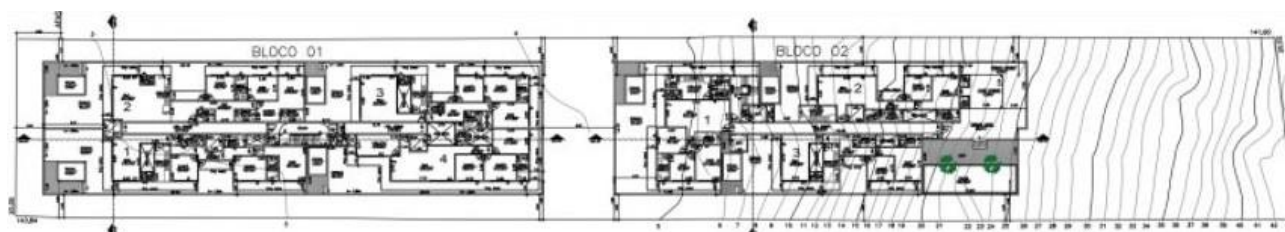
Pavimento Cobertura – Blocos 01 e 02.
